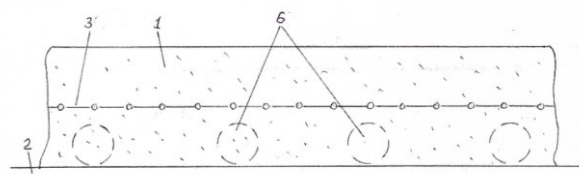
Насыпь с двухслойной системой охлаждения: 1 – насыпь; 2 – основание; 3 – вентиляционное геополотнище (геосетка); 6 – вентиляционные бухты
